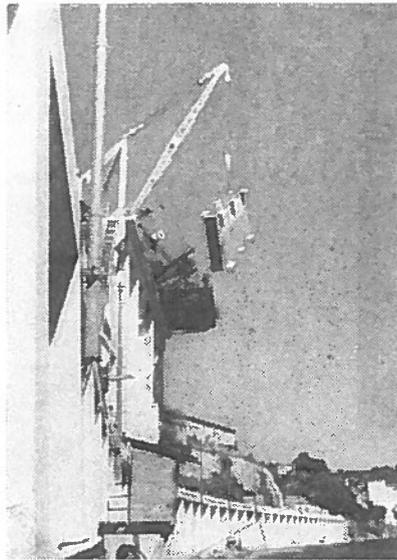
Montagem de um caixão do 3.º troço — Posicionamento
